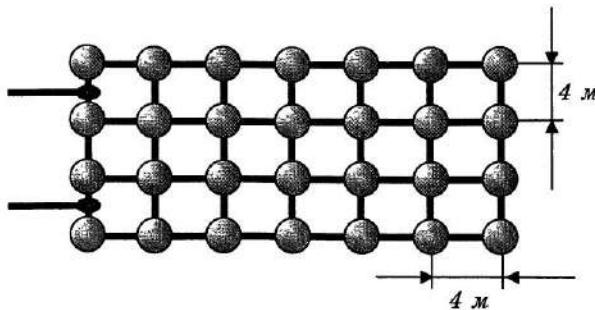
Контур заземляющего устройства (вид сверху)
